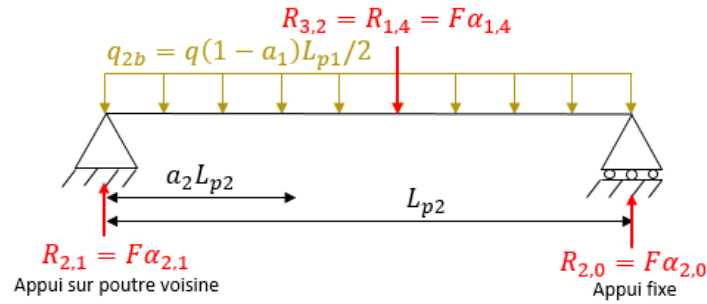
Schéma statique d'une poutre type 2 du plancher rectangulaire avec 2 sens de portée
